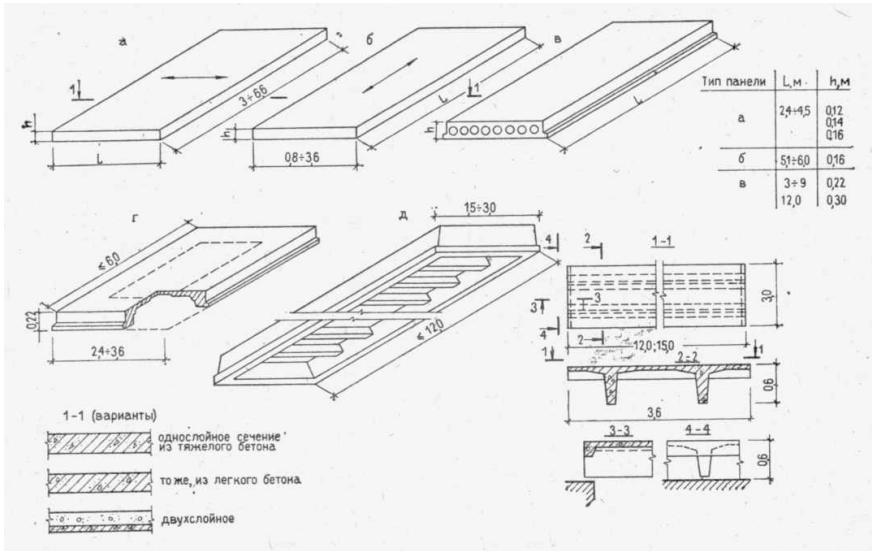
Збірні залізобетонні елементи перекриття: а - суцільна гладка плита; б - багатопустотні панелі; г - шатрові плити; д - ребристі плити та настил 2Т.
